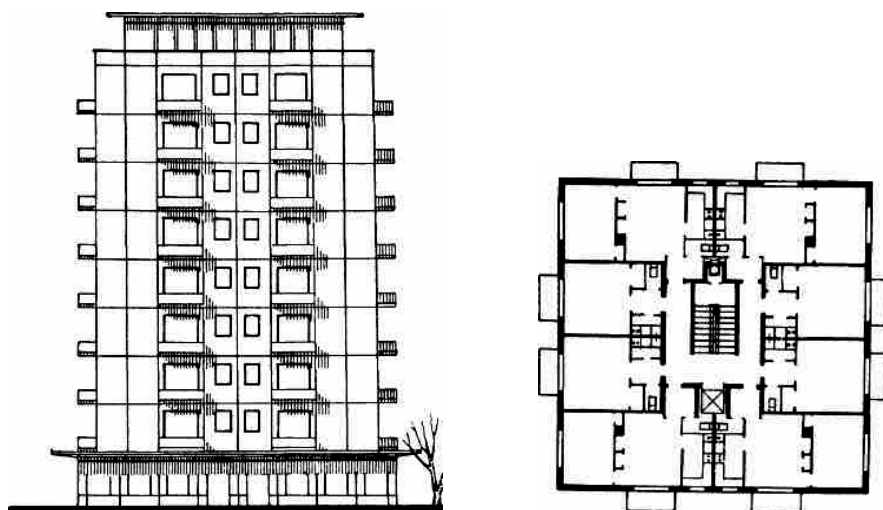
Проект будинку готельного типу, споруджуваного способом підйому поверхів. Фасад і план (Ленгінпрогор), 1979 р.
